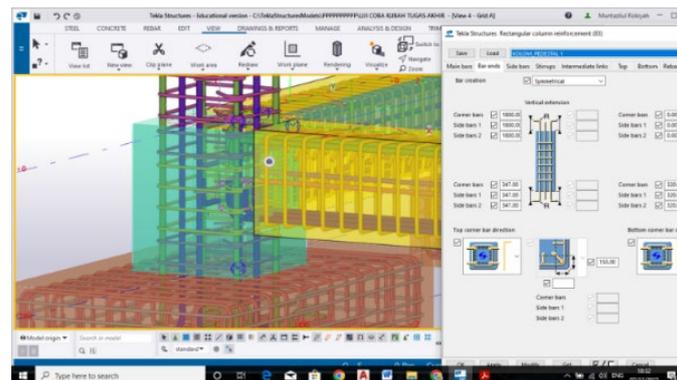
Permodelan Tiang Pancang Struktur Beton Bertulang
